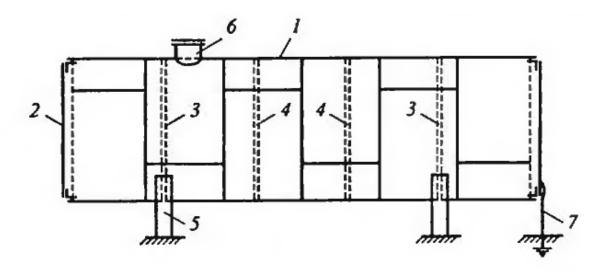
Горизонтальный резервуар с плоскими днищами: 1 — стенка; 2 — днище; 3 — опорная диафрагма; 4 — промежуточное кольцо жесткости; 5 — опора; 6 — лаз; 7 — заземление
